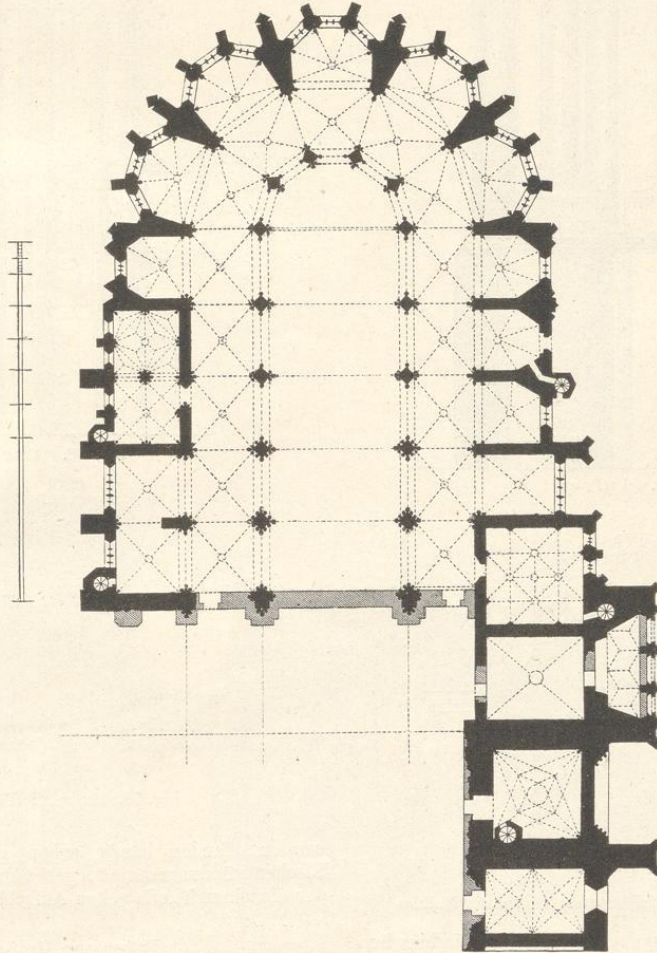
(Prag, unterer Grundriss des Domes.)
